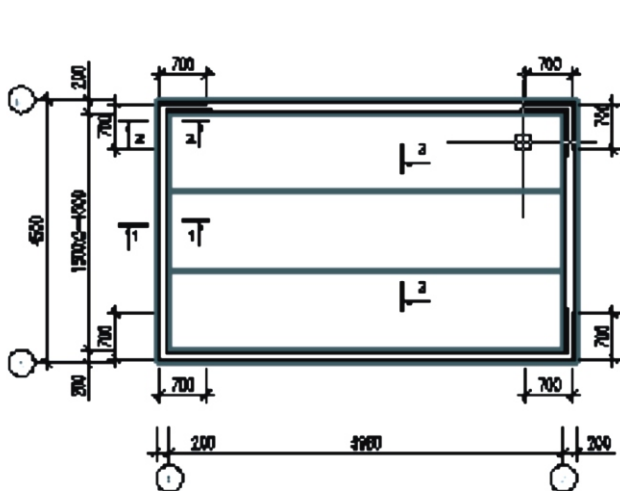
Конструктивное решение второго фрагмента перекрытия
